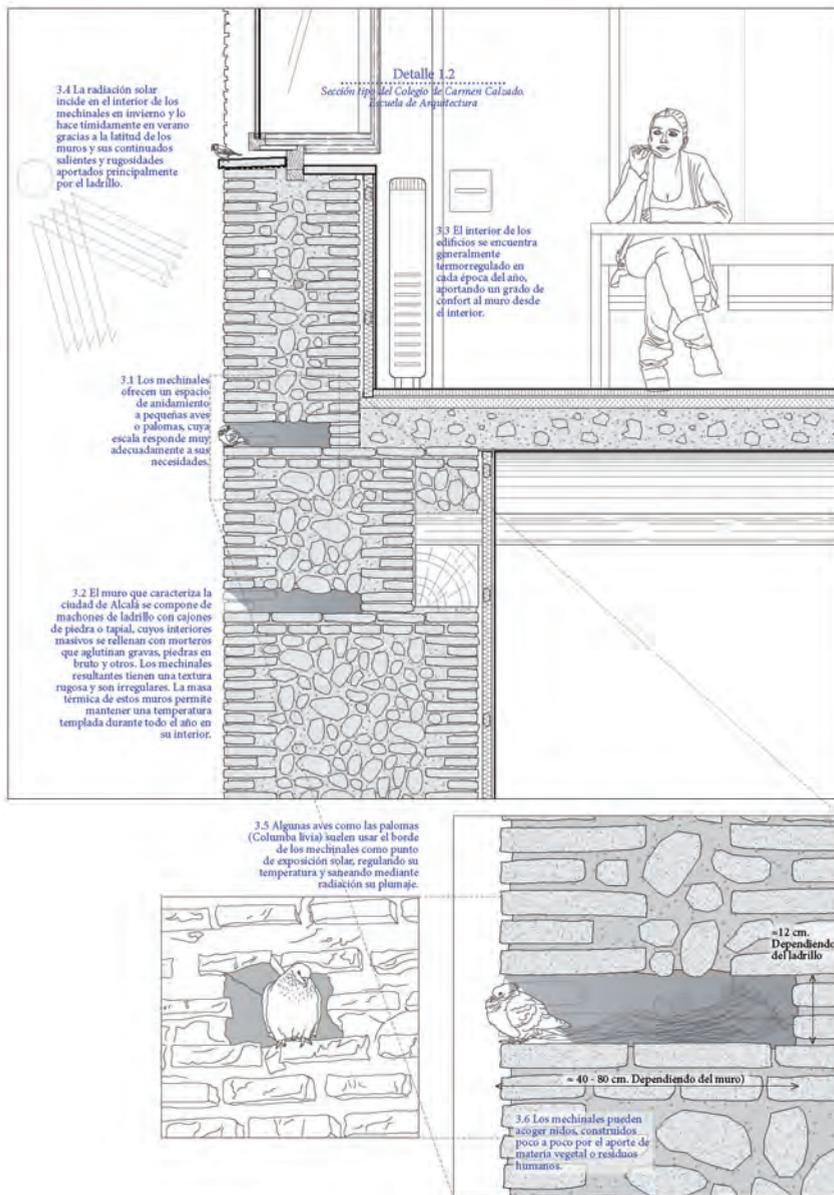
Lámina 3. Sección tipo del muro del Convento de Carmen Calzado. Elaboración de los autores, 2023.
